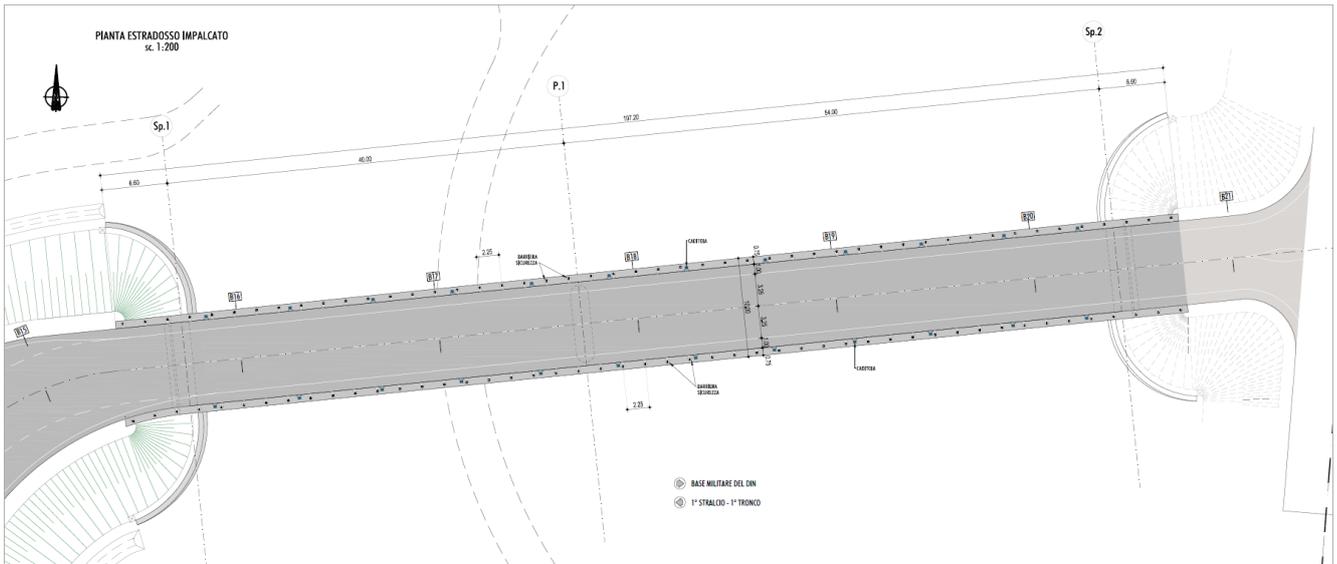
VISTA IN PIANTA DEL PONTE – LIVELLO IMPALCATO
